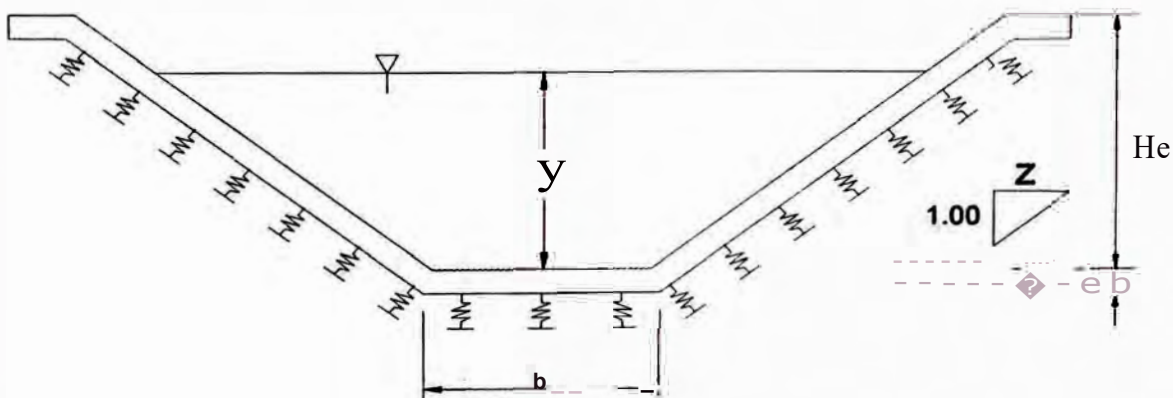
Sección de Canal Trapezoidal apoyado sobre resortes elásticos
